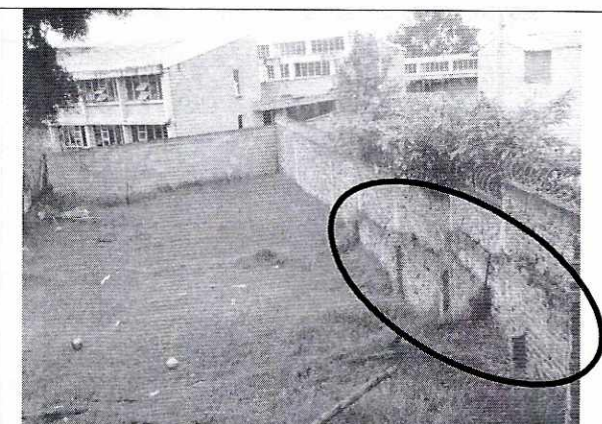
Vista interior zona posterior. Se indica muro de cerramiento del inmueble. No se observa daños
